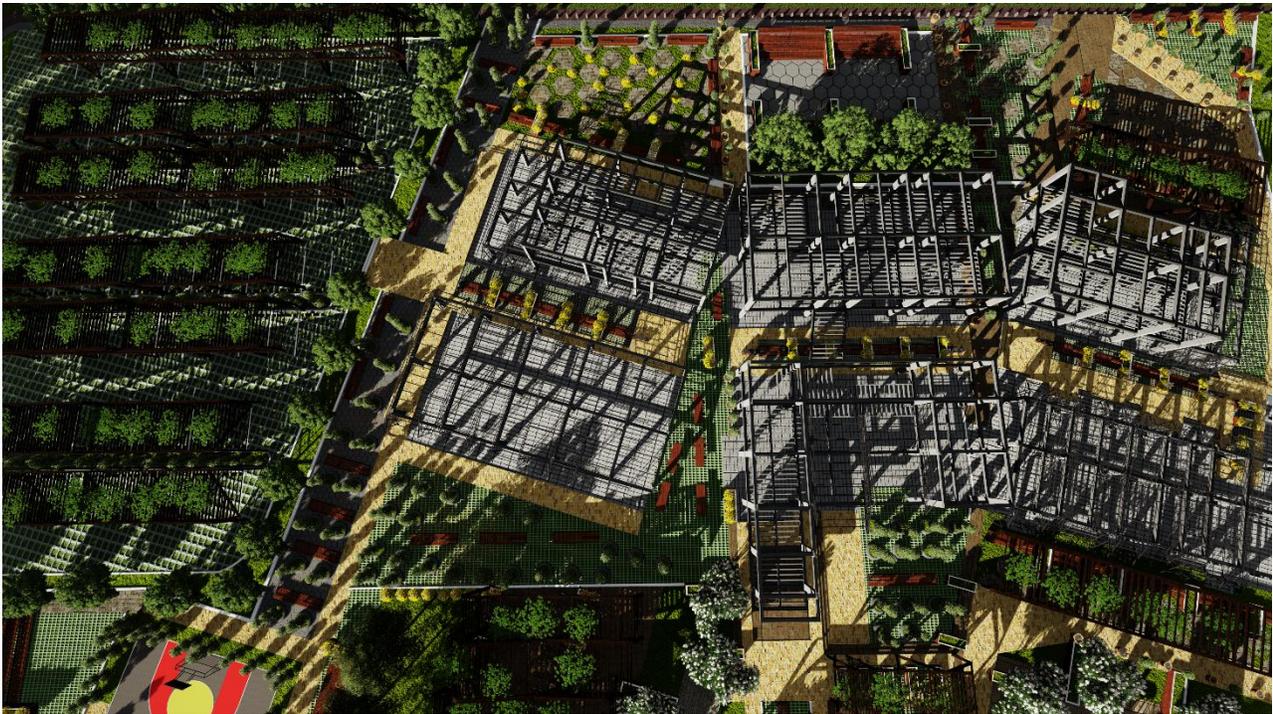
Imagen tridimensional de la estructura, en perspectiva 2.
